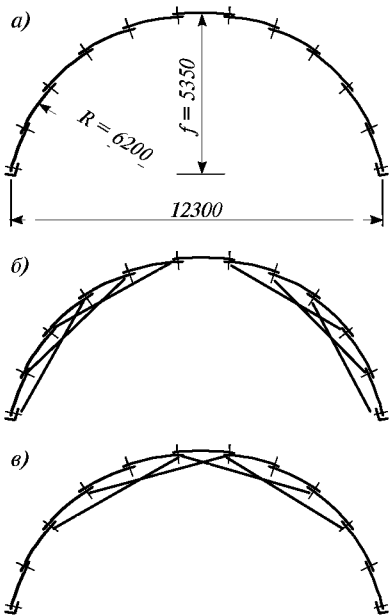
Варианты поперечного сечения здания «Волна-360»
